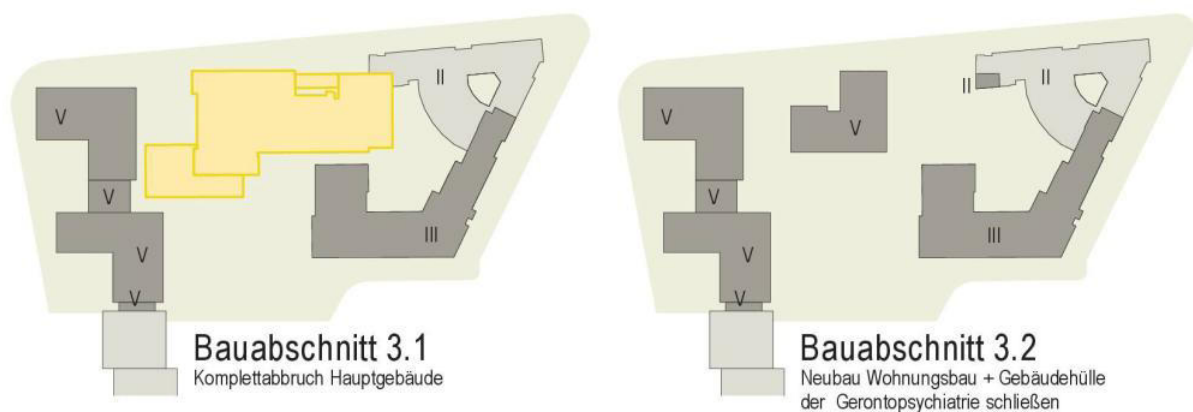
Bauabschnitt 3.1 (Abbruch Hauptgebäude) /3.2 (Neubau Wohngebäude)
